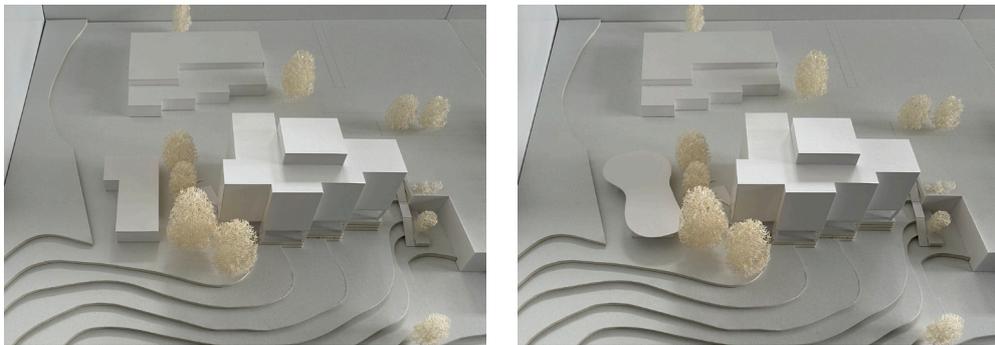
Varianten Neubau westlich Oberstufenschulhaus
